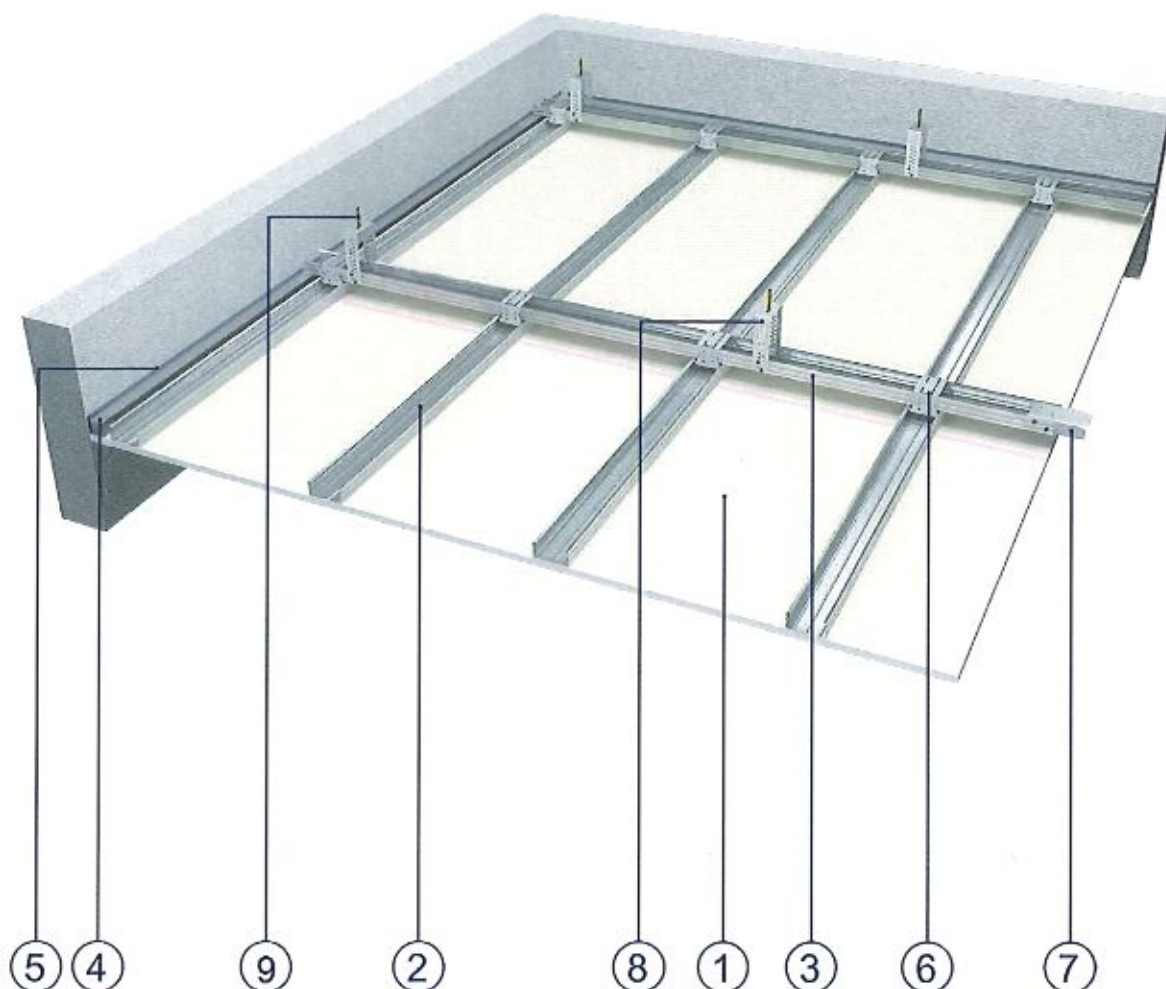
Widok sufitu podwieszanego – konstrukcja krzyżowa dwupoziomowa na wieszakach obrotowych ze sprężyną
